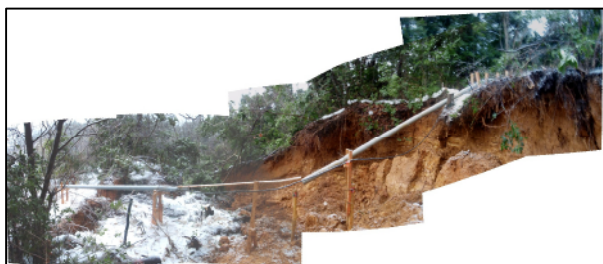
頭部の陥没帯および伸縮計 S-1設置状況
